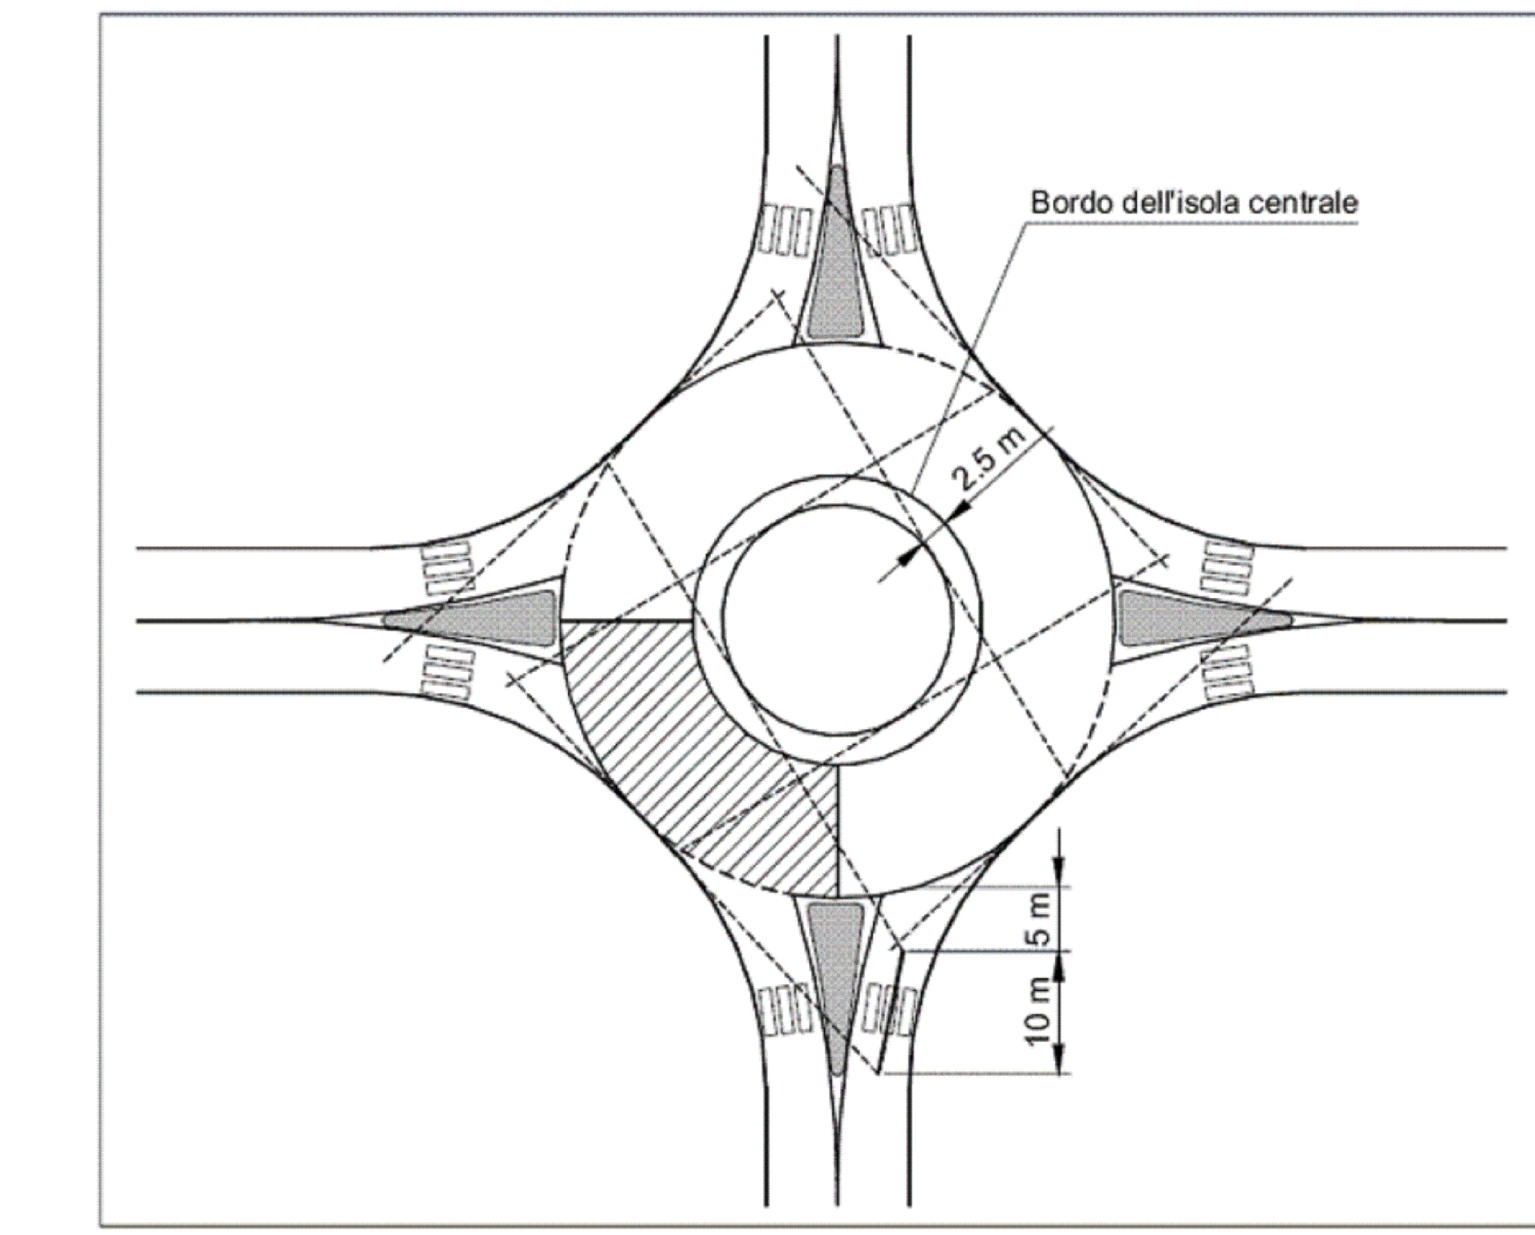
Elementi di progetto e tipizzazione delle rotonde
